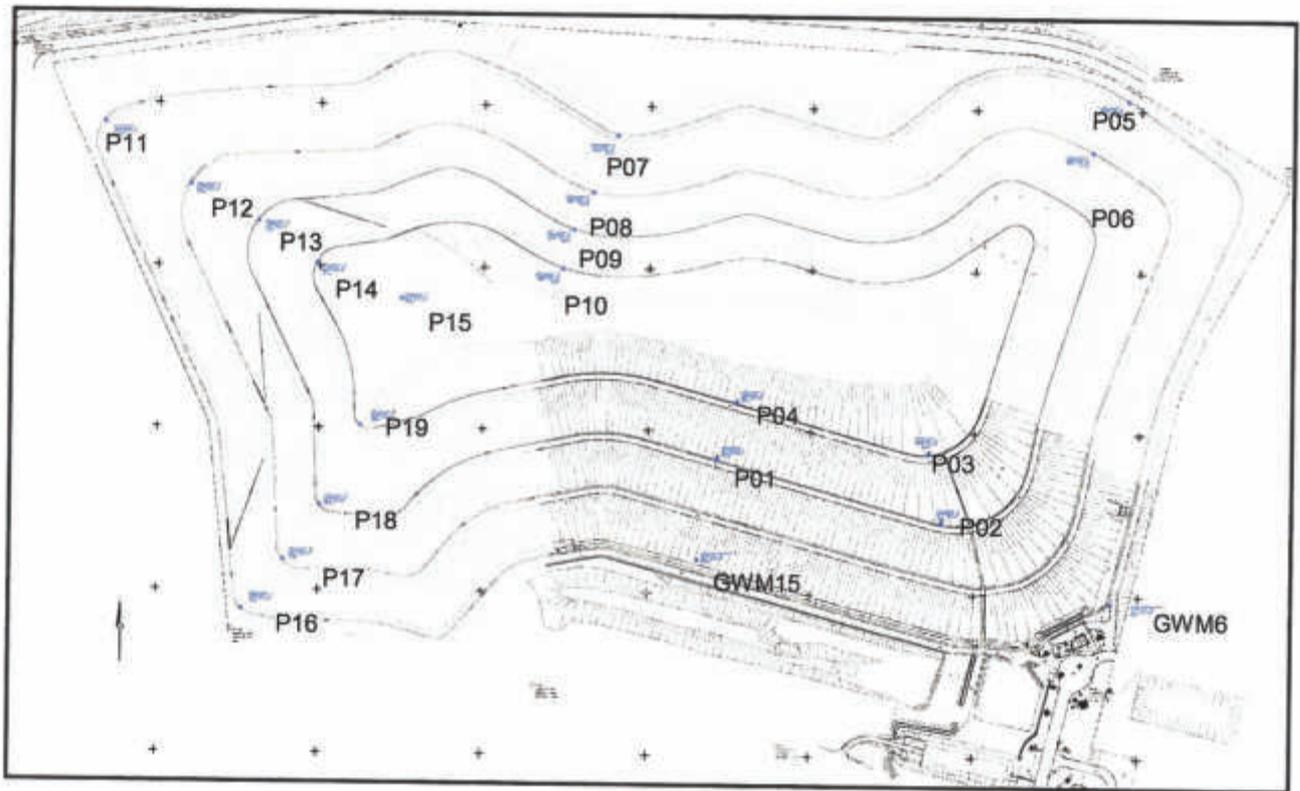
Lageplan mit Setzungsmesspunkten Altdeponie
